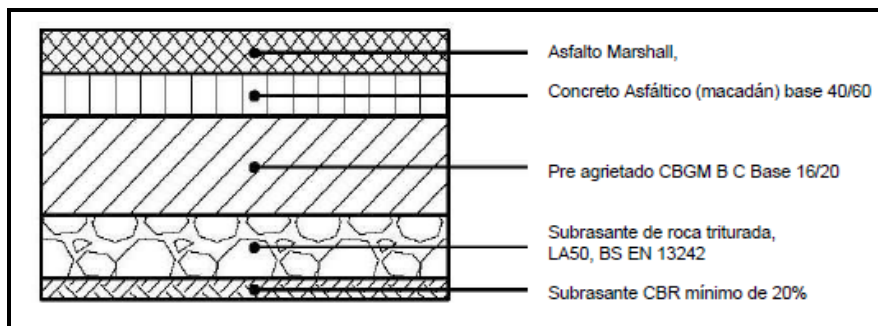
Detalles de construcción de una pista y calle de rodaje típica flexible con Código E / F (típico).
